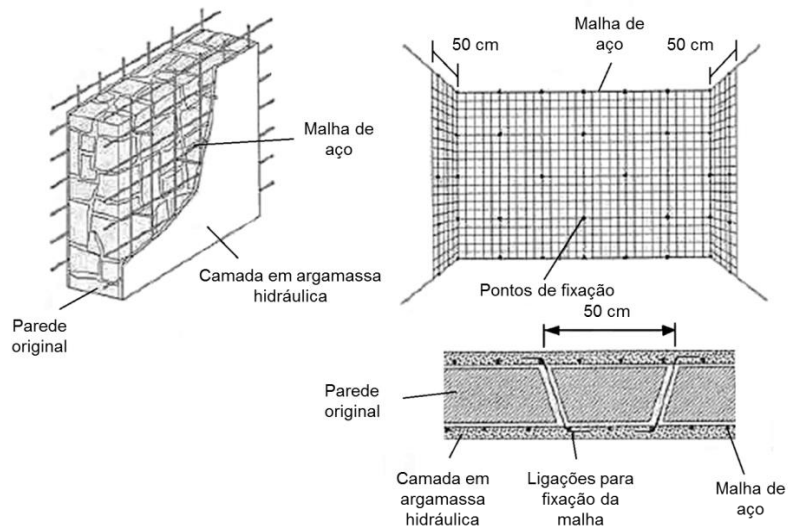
Reboco armado. Pormenores da fixação da malha de reforço (adaptado de Roque & Lourenço, 2003)
